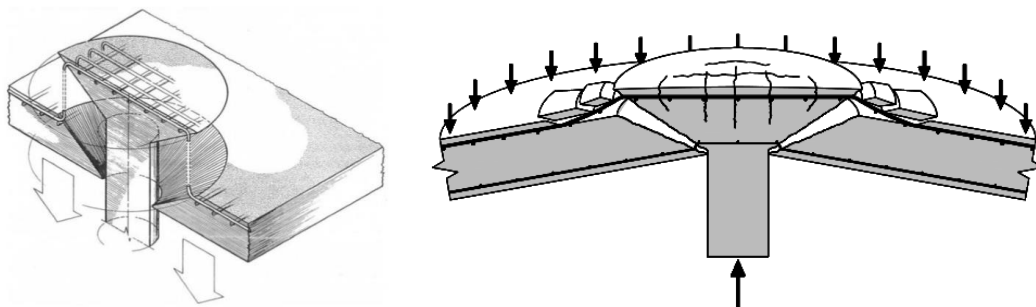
Esquema de rotura ao punçoamento de uma laje de betão armado [9] e [10]
